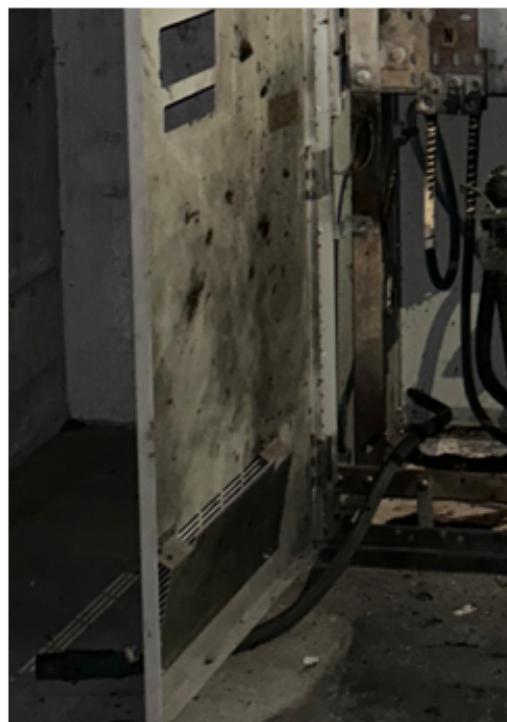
Câble de neutre génératrice sur le plancher et prêt à être installé
